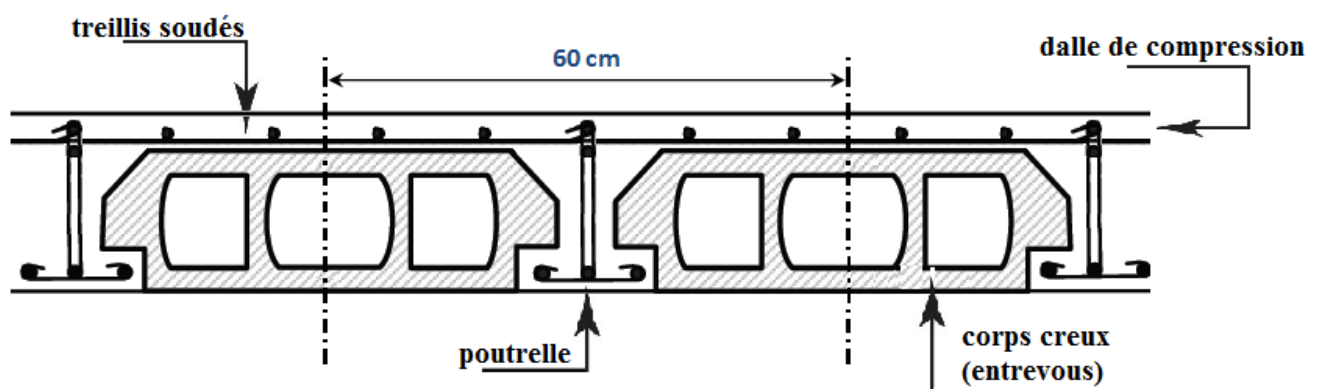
Coupe transversale d'un plancher à corps creux.
